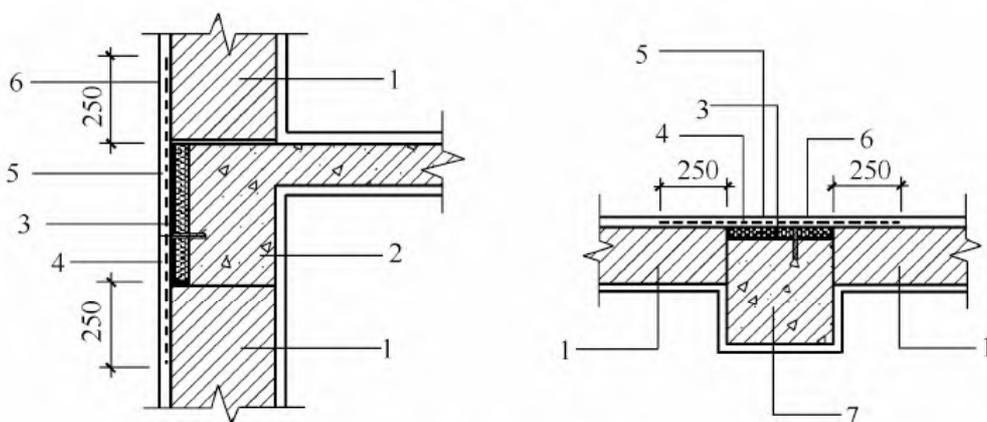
梁、柱与墙体交接处保温处理的构造做法示意
